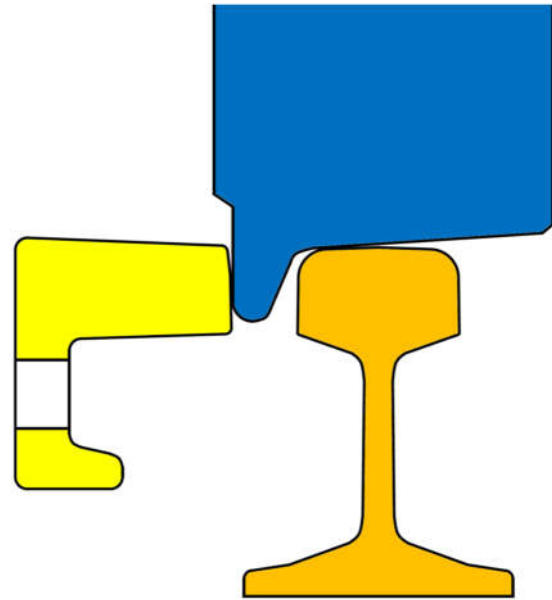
Situazione della linea di Trogen, senza sopraelevazione della controrotaia rispetto al piano del ferro
